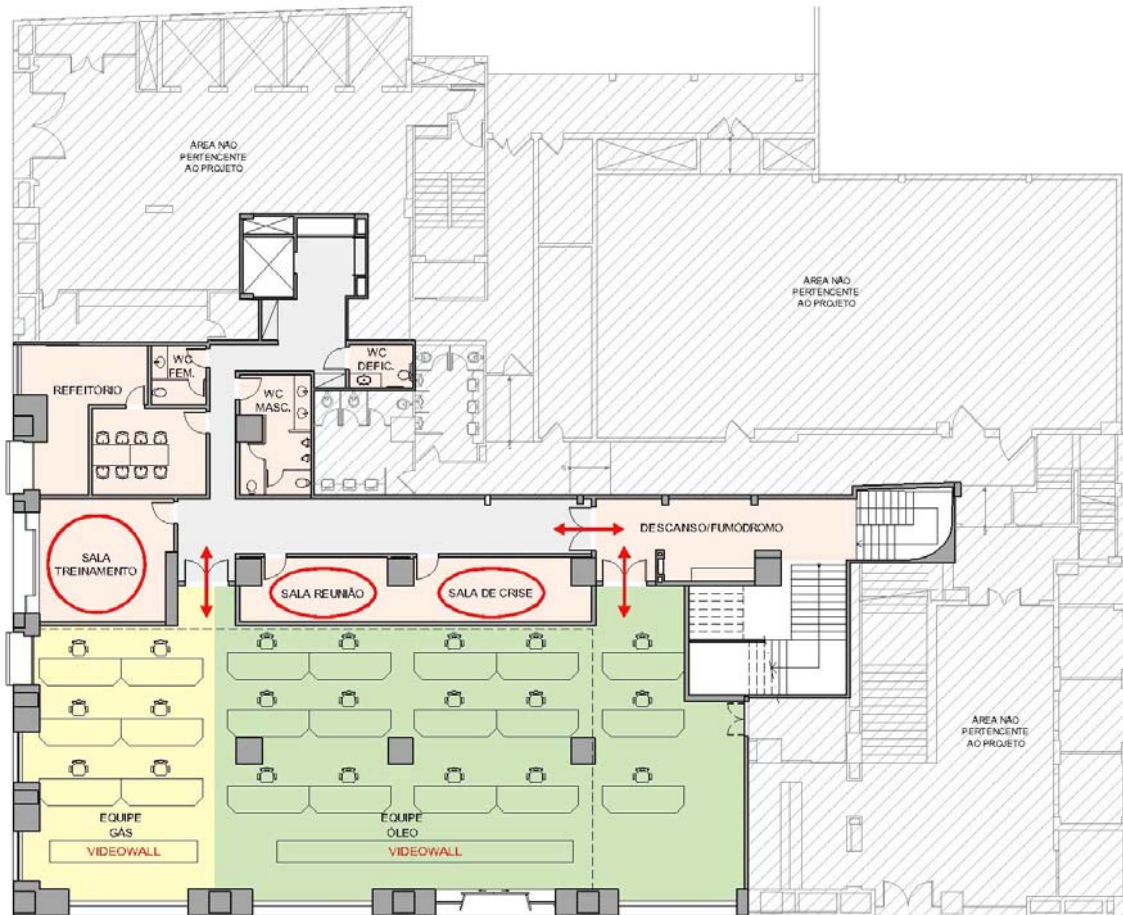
Planta baixa pavimento térreo: opção 3 para o layout (oito de junho)
